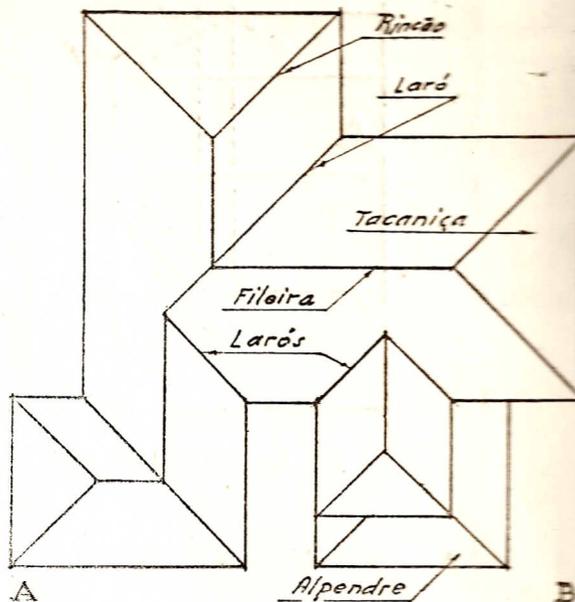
PLANTA DE UM TELhado MOVIMENTADO
